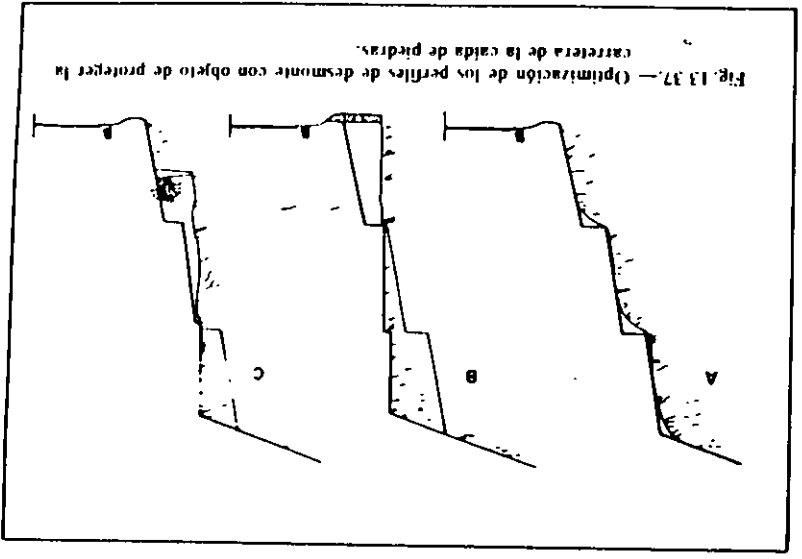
(Optimización de los perfiles de desmonte con objeto de proteger la carretera de la caída de piedras.
